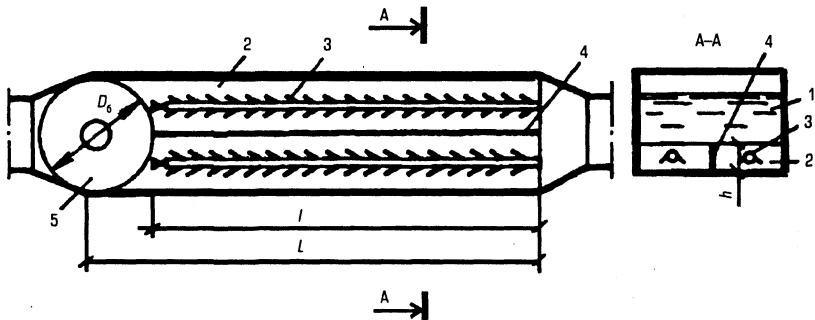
Схема горизонтальной песколовки с гидромеханической системой удаления осадка:
